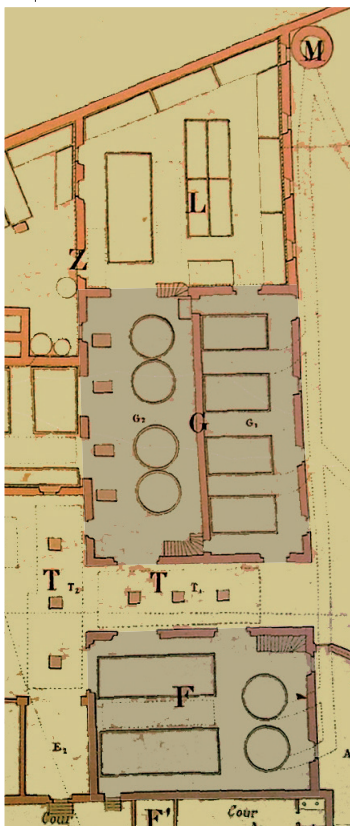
Les bâtiments F et G (détail du plan de 1884).
